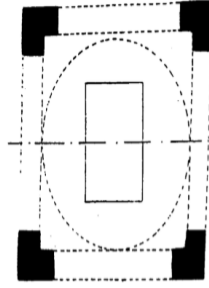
مسقط أفقي لمدفن محمد حافظ بك إبراهيم.
